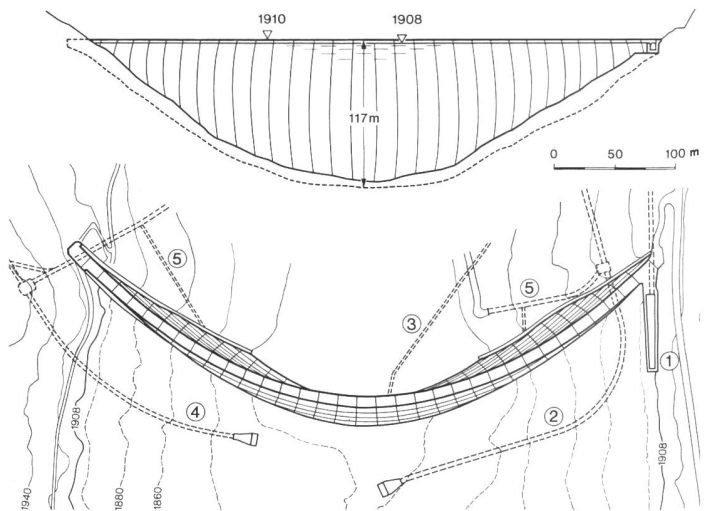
Die Staumauer Sta. Maria. 1 Hochwasserüberfall, 2 Grundablass, 3 Drainagestollen, 4 Druckstollen, 5 Zugangsstollen.
